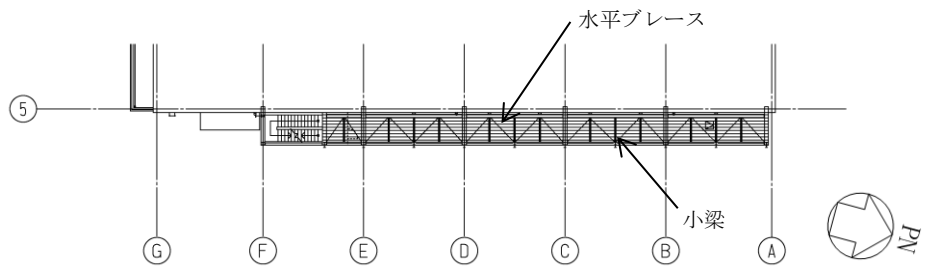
(2) 免震重要棟鋼製バルコニーの2階平面図
